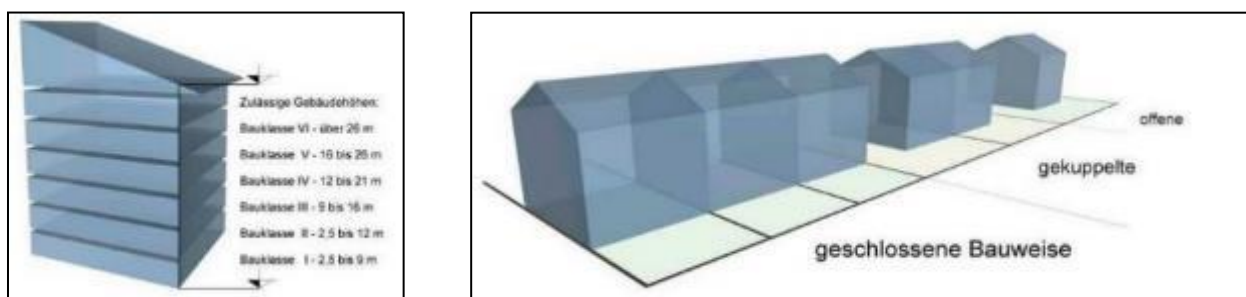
Bauklassen (links) und Bauweisen (rechts) nach Wiener Bauordnung
